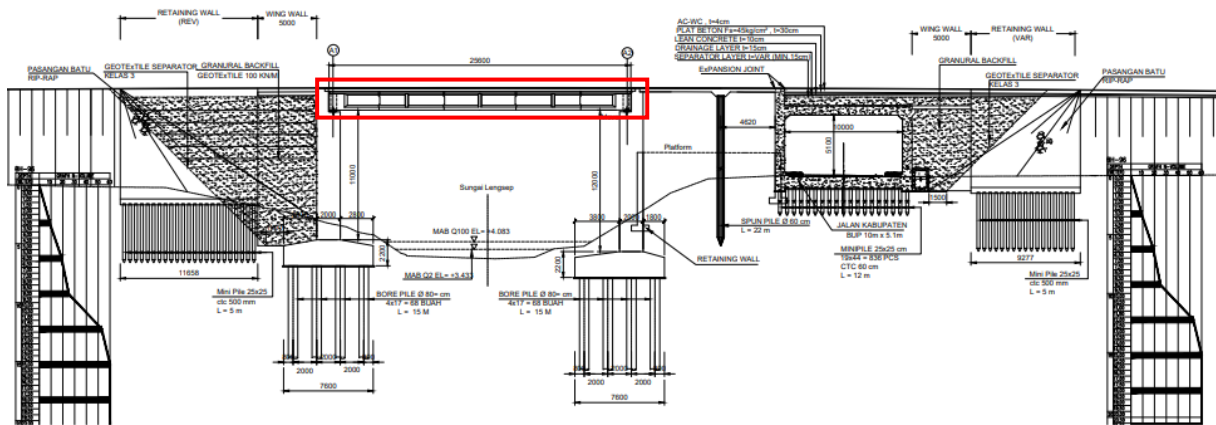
Layout *Erection* Girder Jembatan Lengsep
